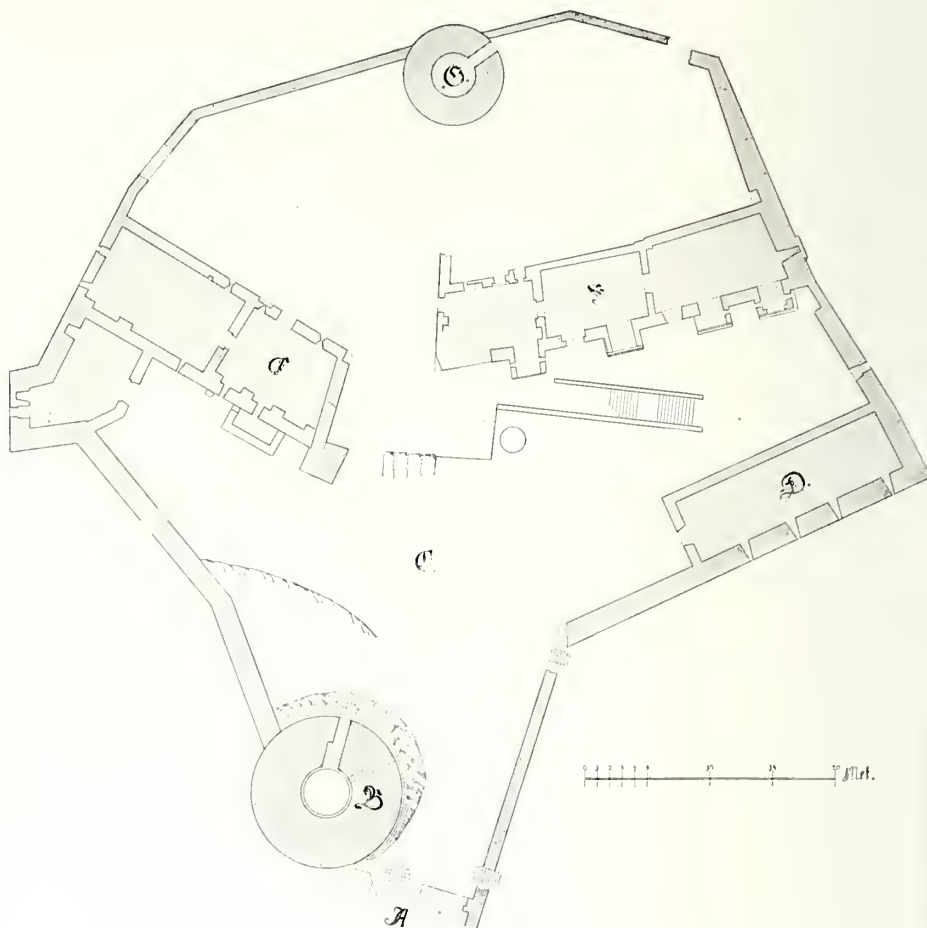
Hartenstein, Ruine. Grundriß 1 : 600 (S. 119)
